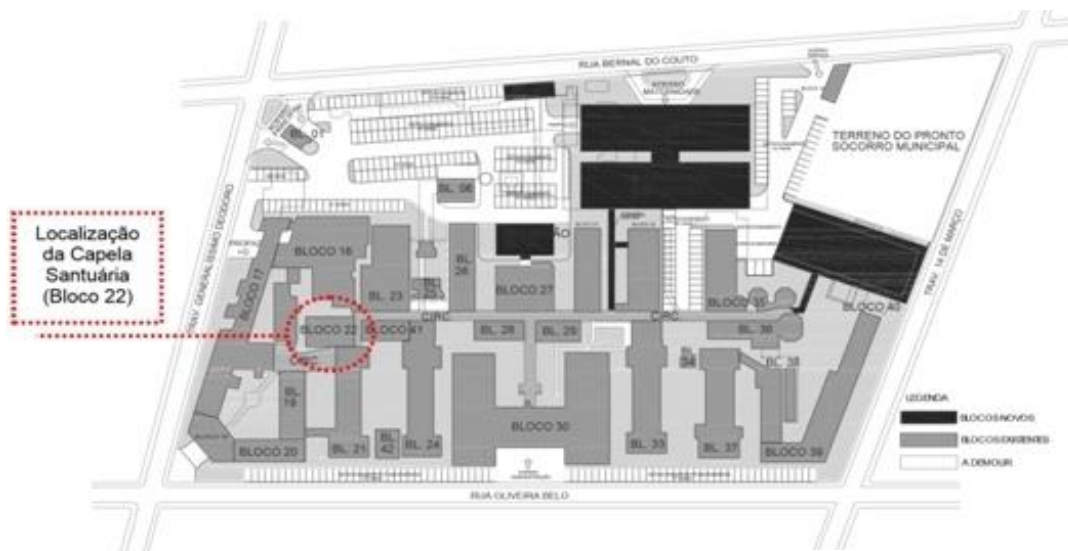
Planta Baixa o 1º Pavimento do Hospital Beneficente Portuguesa com Localização da Capela
